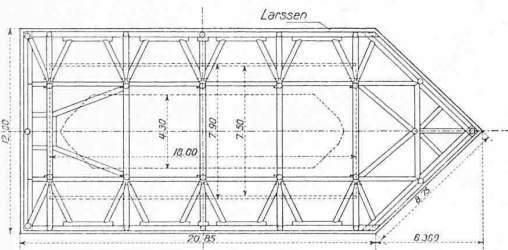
Grundriss der offenen Baugrube, 1 : 400.
